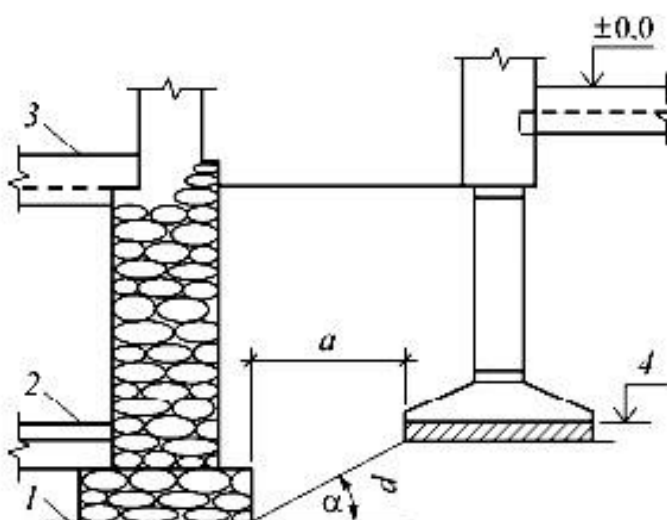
Устройство нового фундамента на разных отметках с ранее существующим фундаментом соседнего здания: 1 – подошва существующего фундамента; 2 – пол подвала; 3 - перекрытие первого этажа; 4 – отметка заложения проектируемого фундамента [144]
